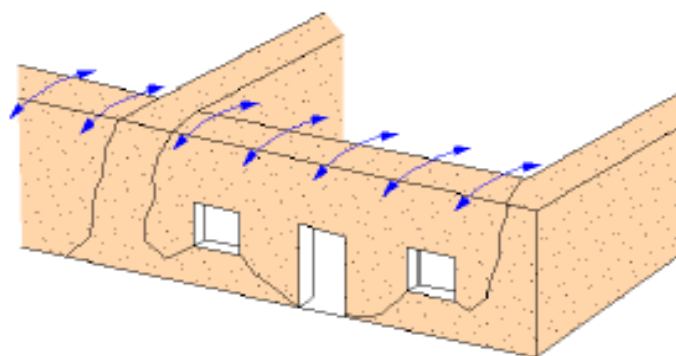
Fissuration par flexion hors plan d'un mur bien contreventé latéralement
